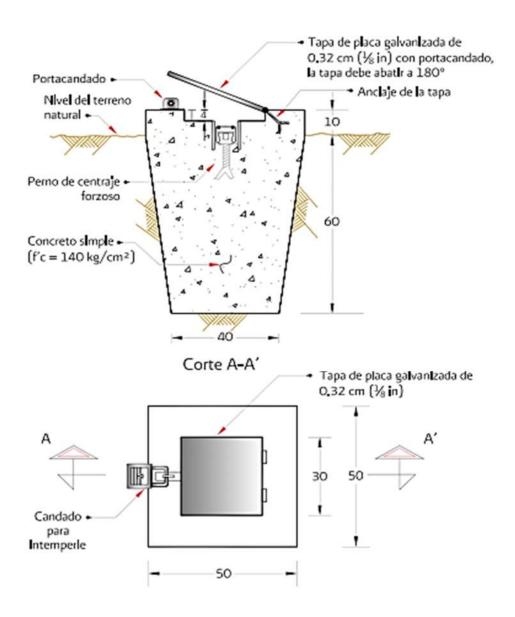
III.3.3.1.1.2 Testigo superficial para medir movimientos verticales (TSMV).
